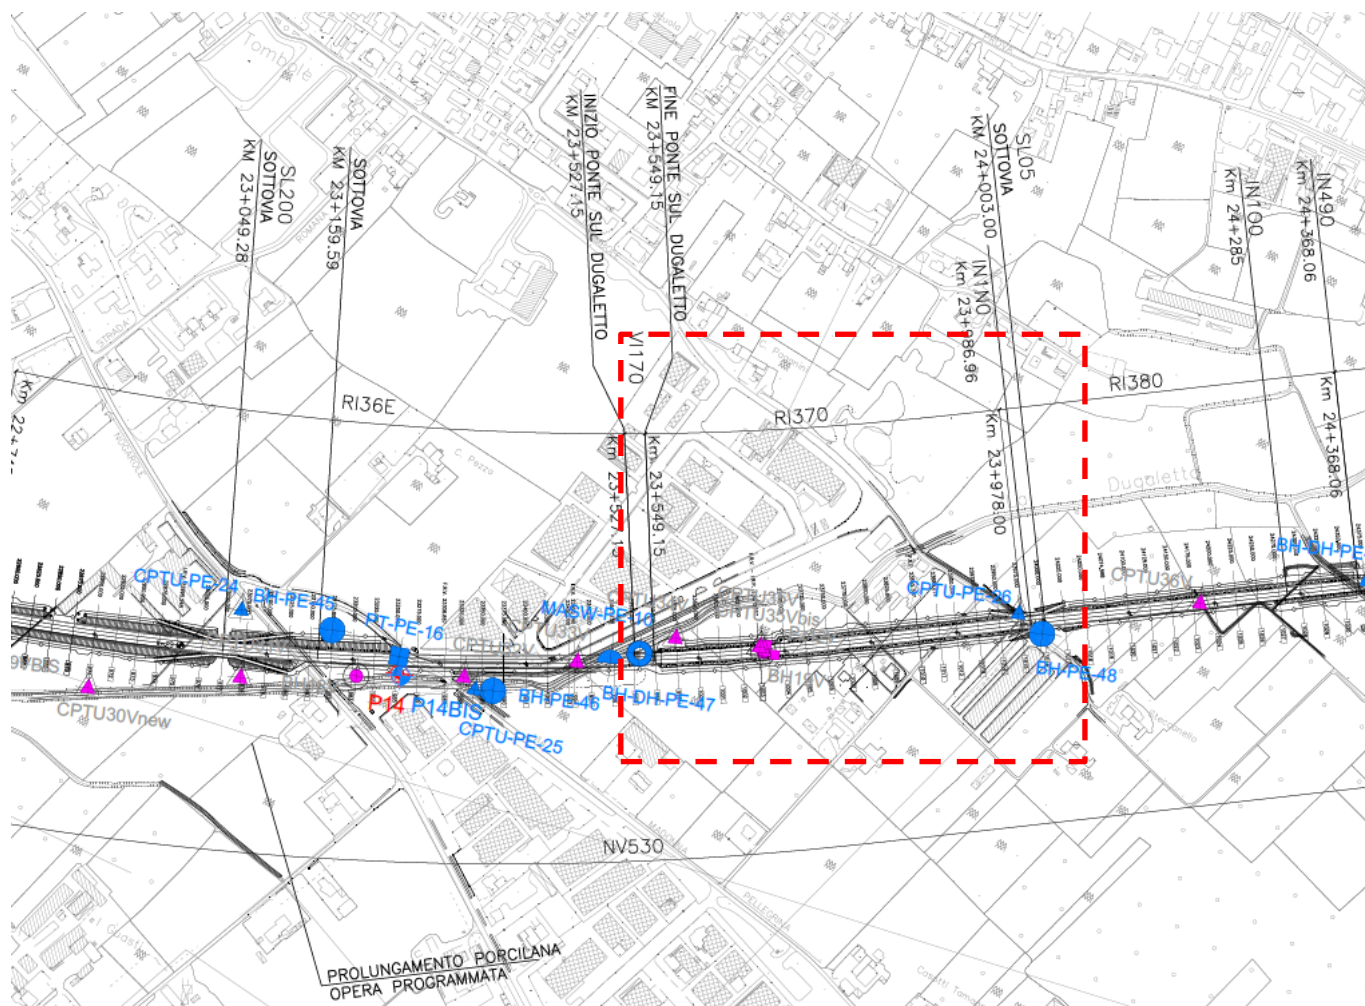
Planimetria Rilevato RI37, estratto dalla Planimetria Generale (Doc. Rif[3])
